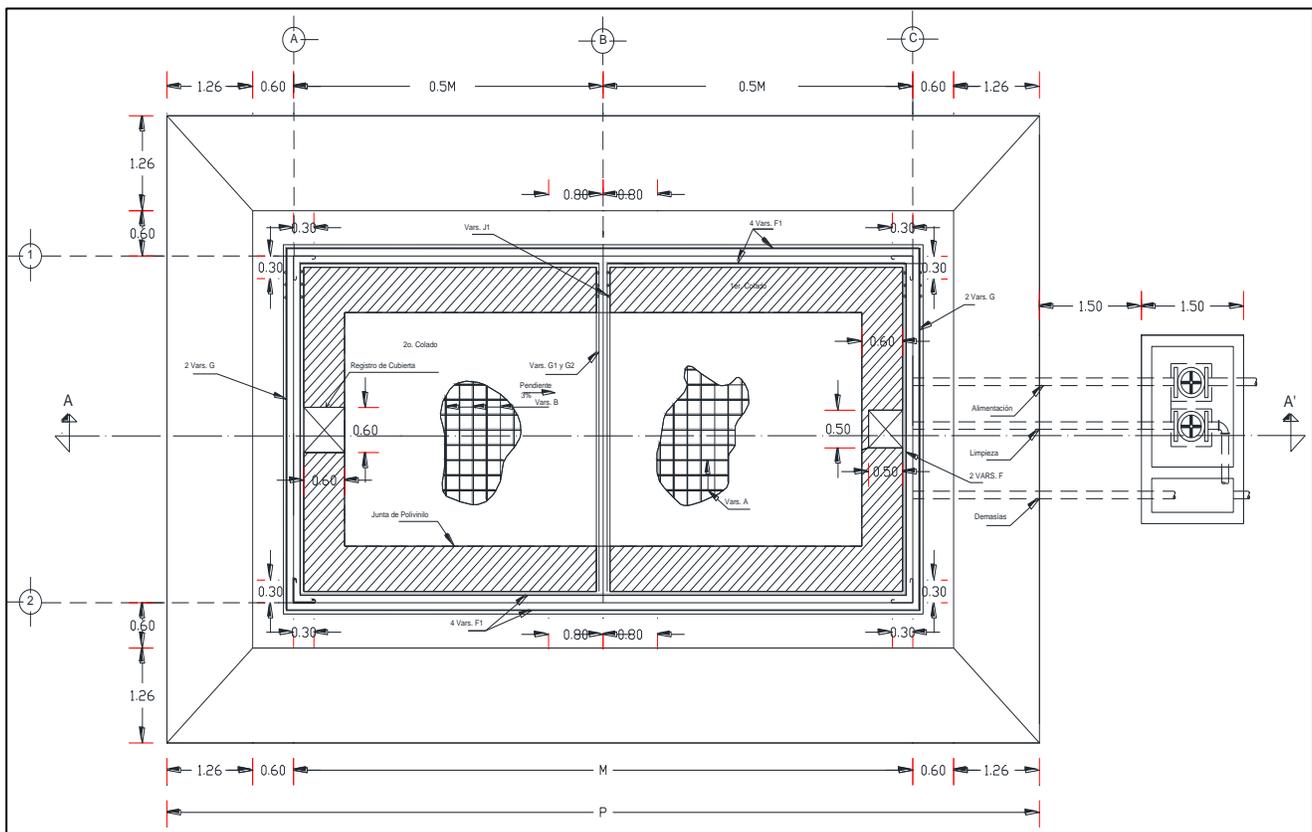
Armado de losa superior en tanques de mampostería, planta elevación 2.90.
